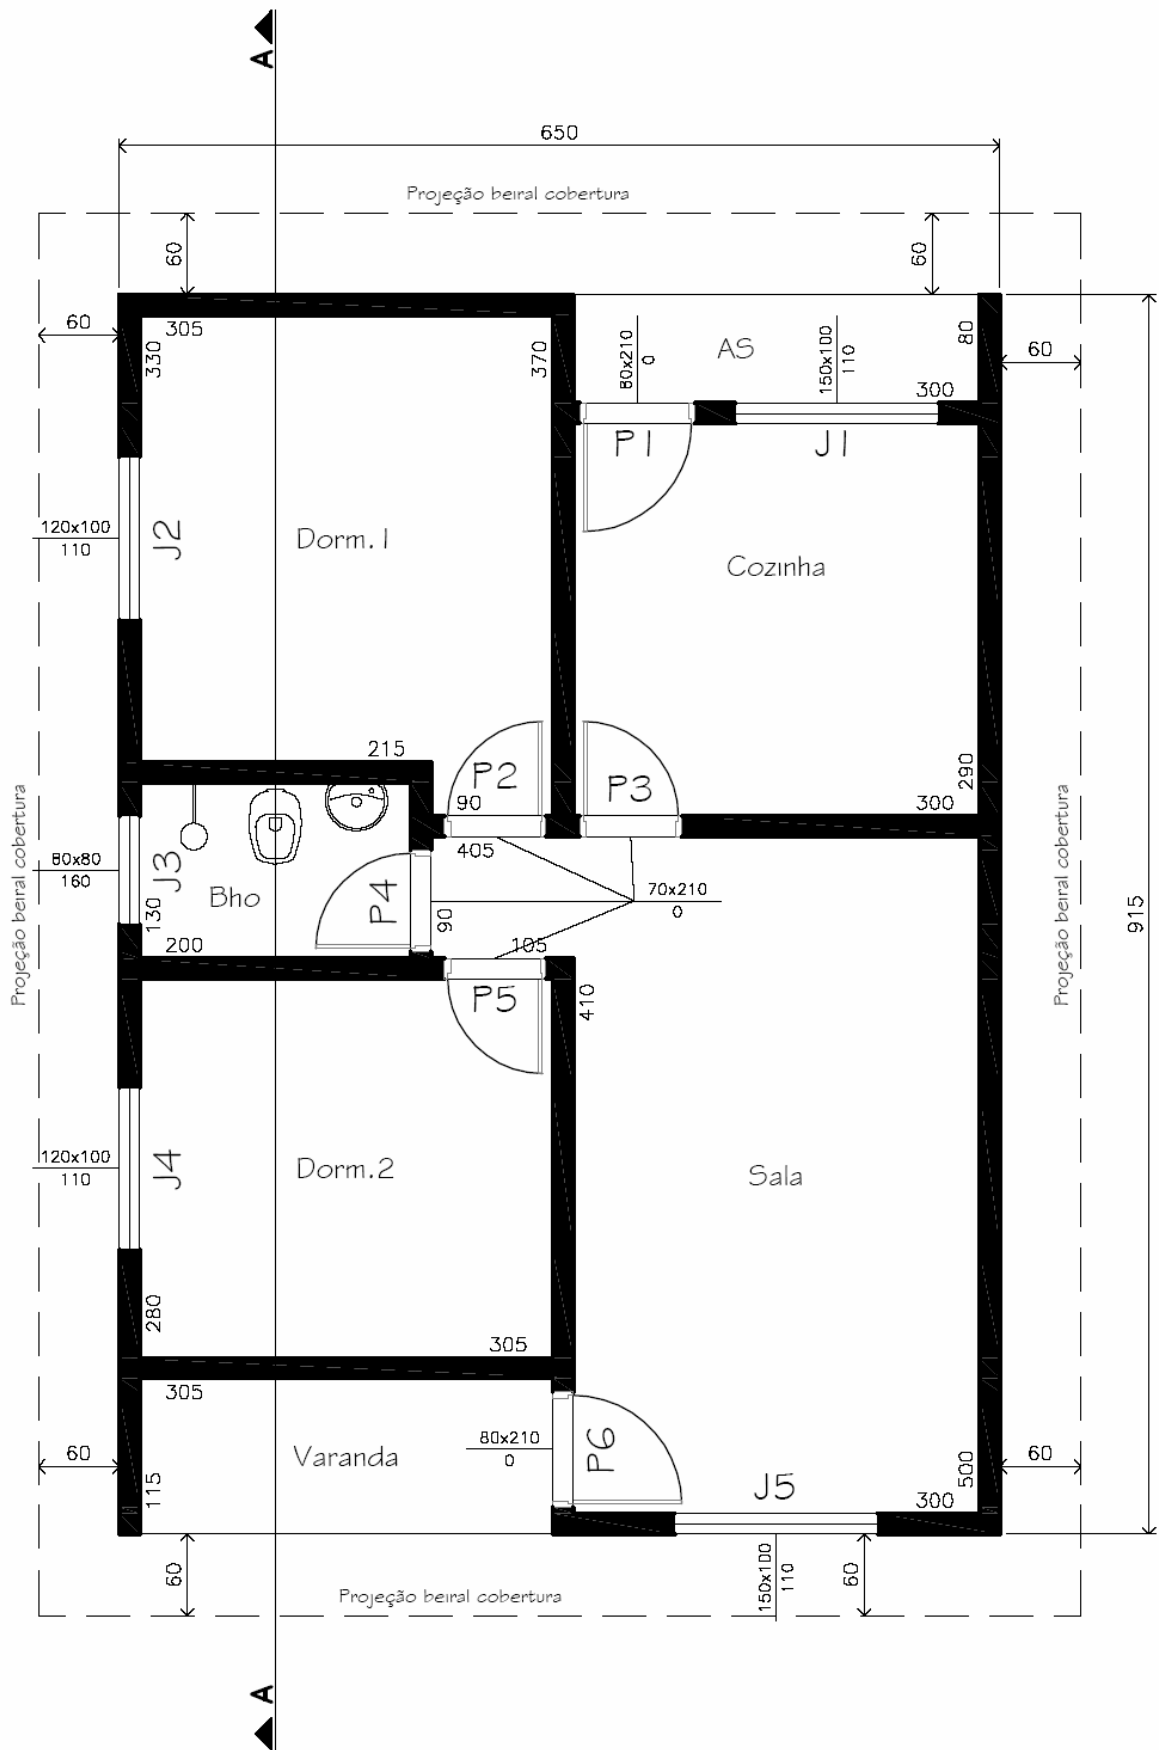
Arquitetura do Exemplo 1: Planta baixa
